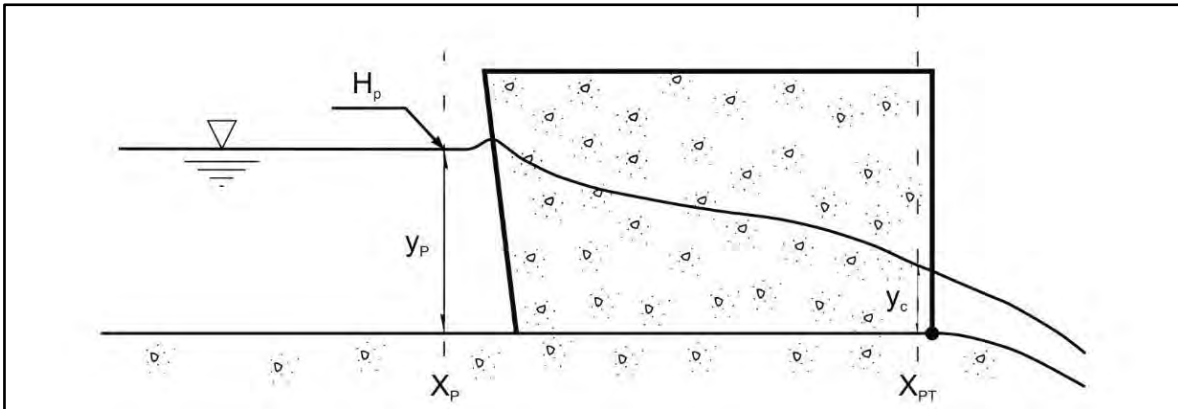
Características del perfil hidráulico en el tramo donde están las pilas
